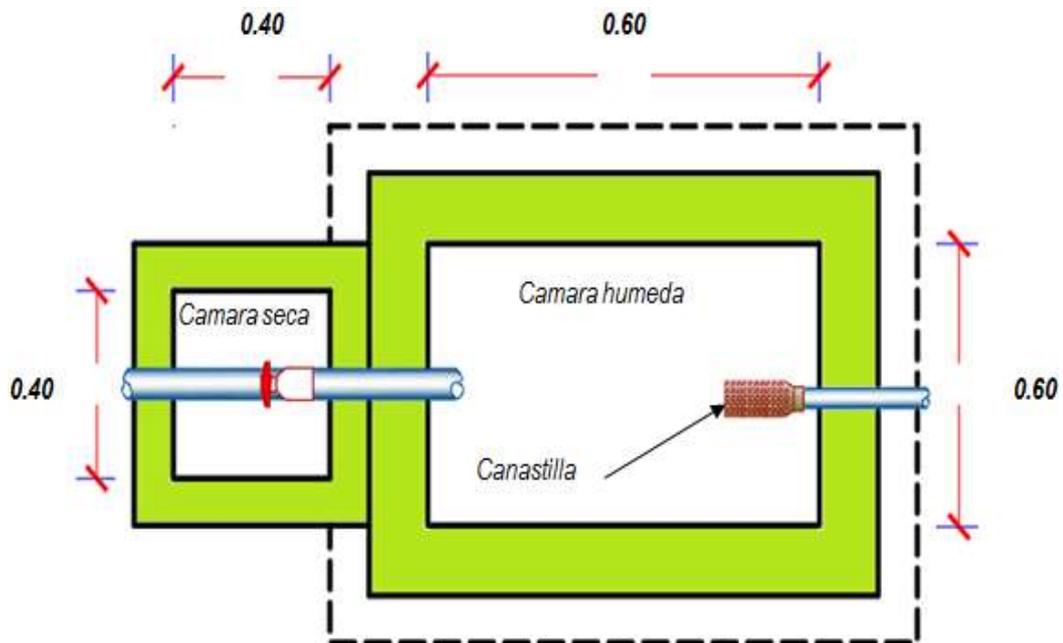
Vista planta de CRP-VI medidas aproximadas según cálculo
